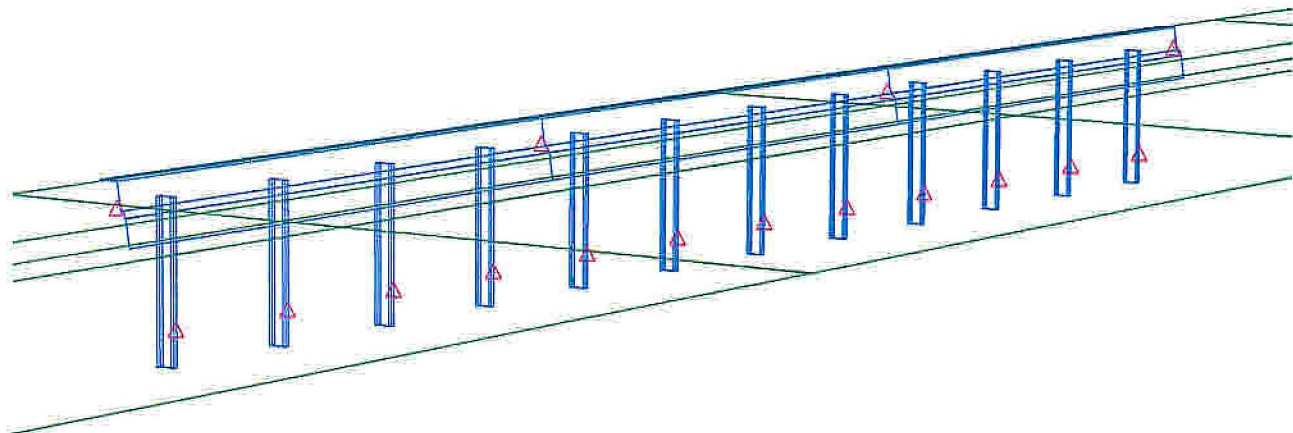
Aanzicht Mini Halve Step-barrier.
